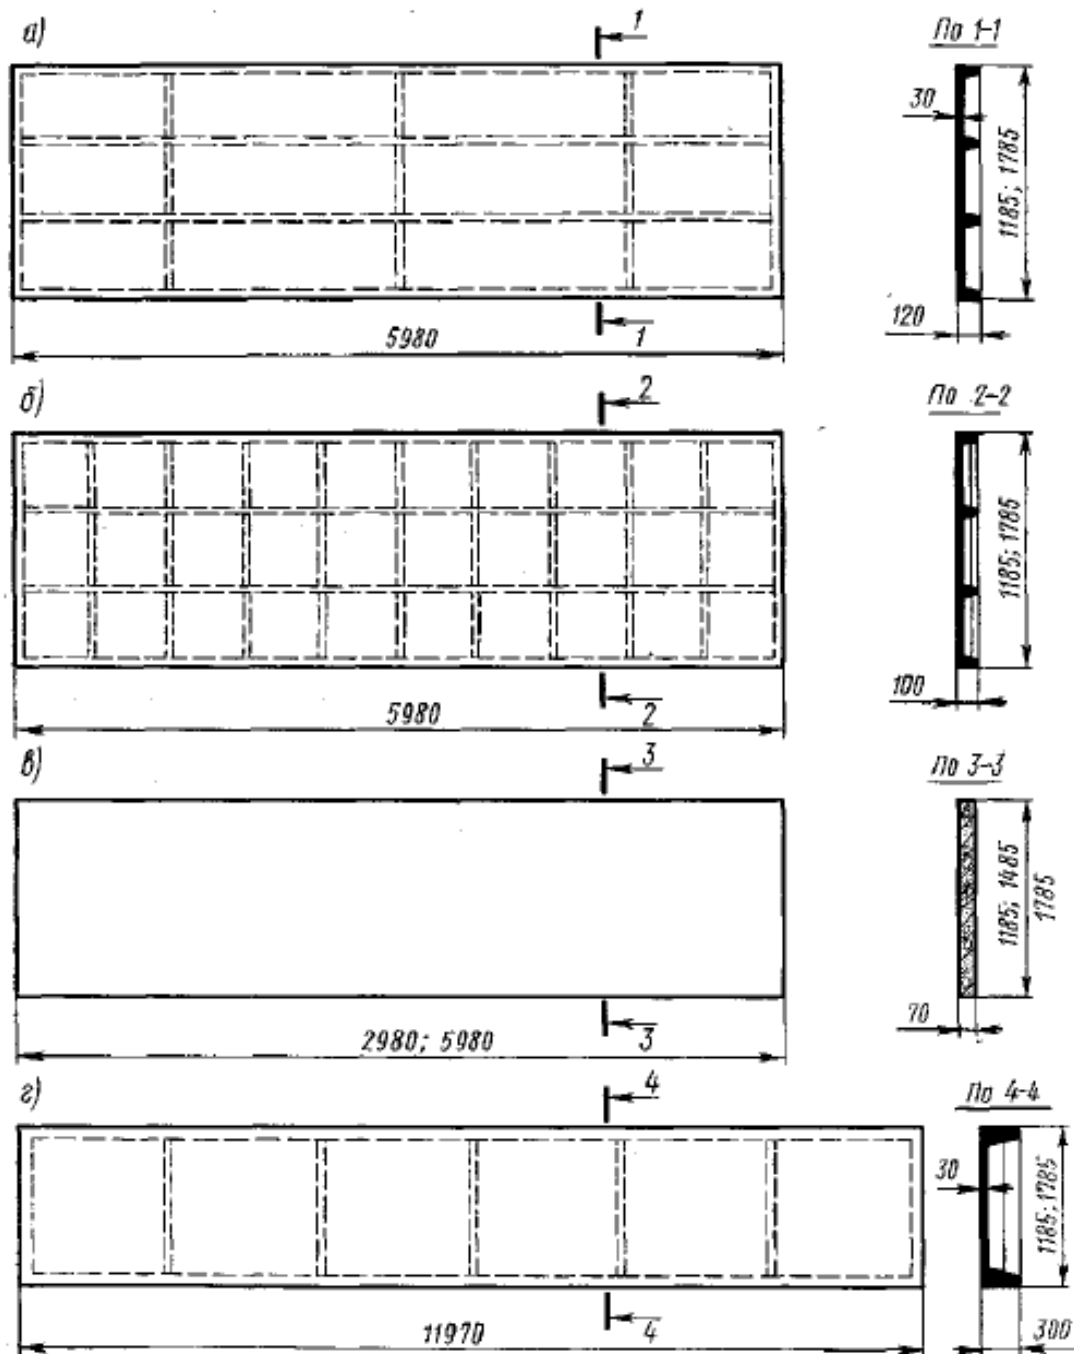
Железобетонные стеновые панели для неотапливаемых зданий:
